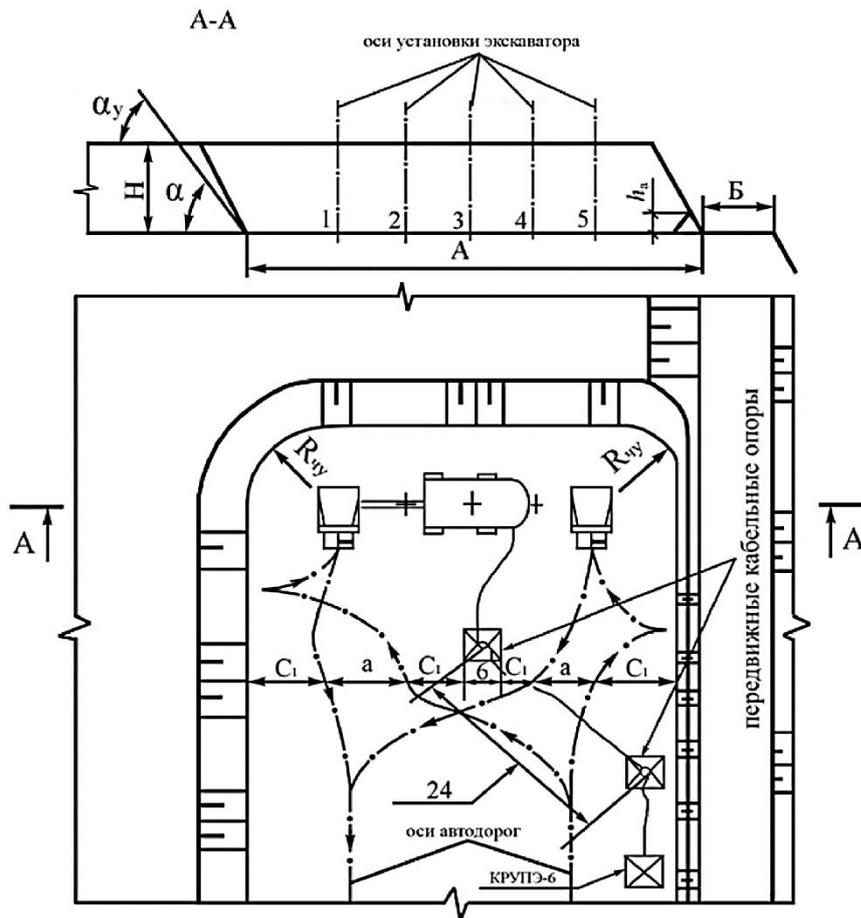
Паспорт забоя для разработки вскрышного уступа широкой заходкой с двухсторонней установкой автосамосвалов под погрузку
